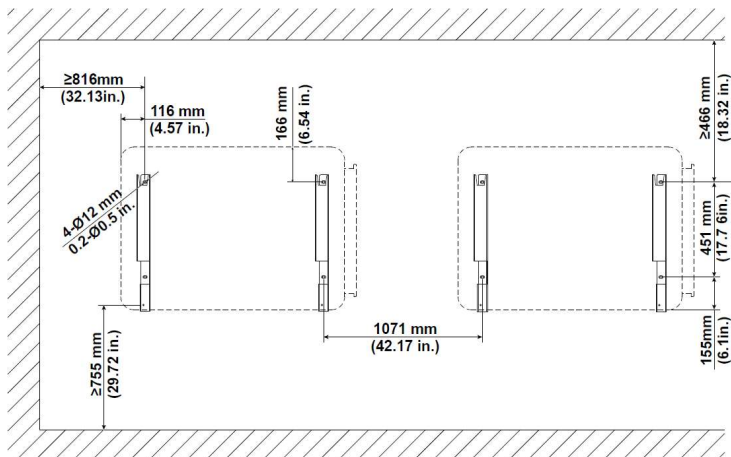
Dimensões da posição dos orifícios de vários suportes de montagem
